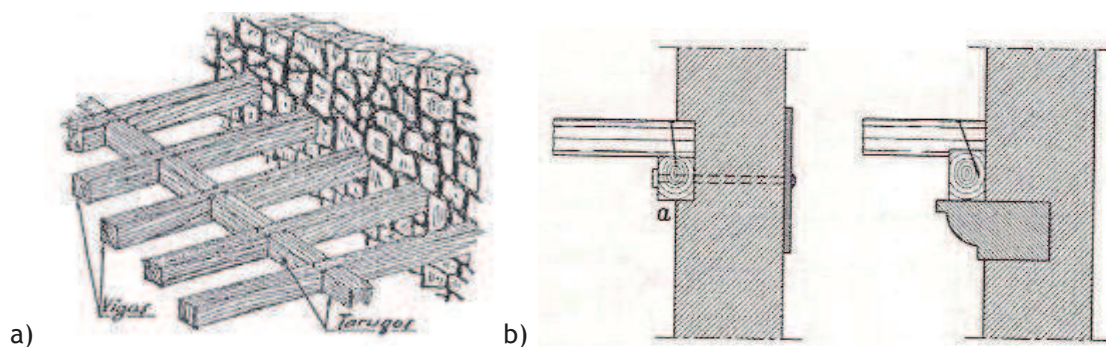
Ligações de vigas: a) encastramento direto na parede [Costa, 1955]; b) apoio em frechal fixado com ferrolho e apoio em frechal assente sobre cachorro de cantaria [Leitão, 1896].
